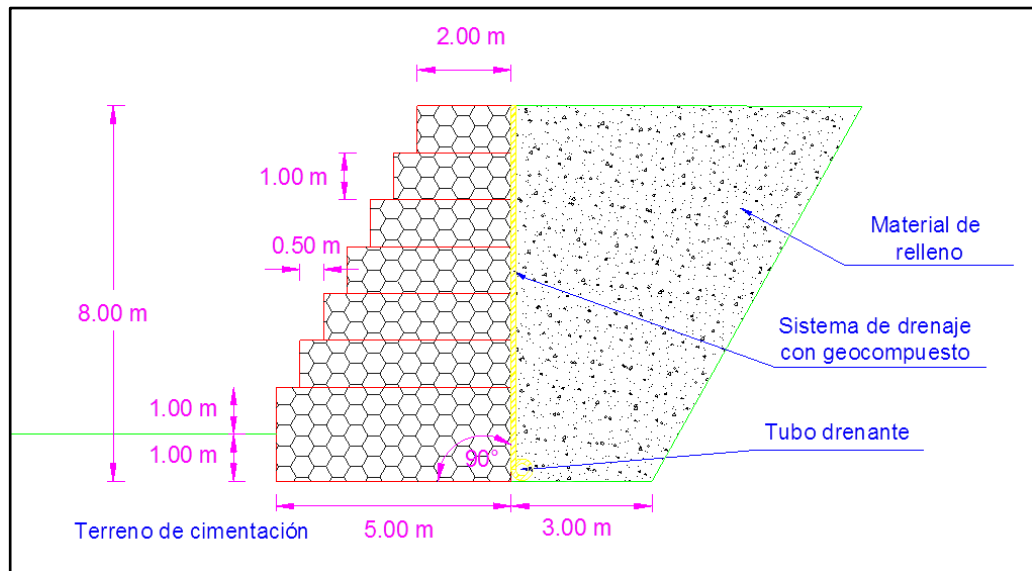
Detalle del muro de gaviones. Pie del talud 5.
